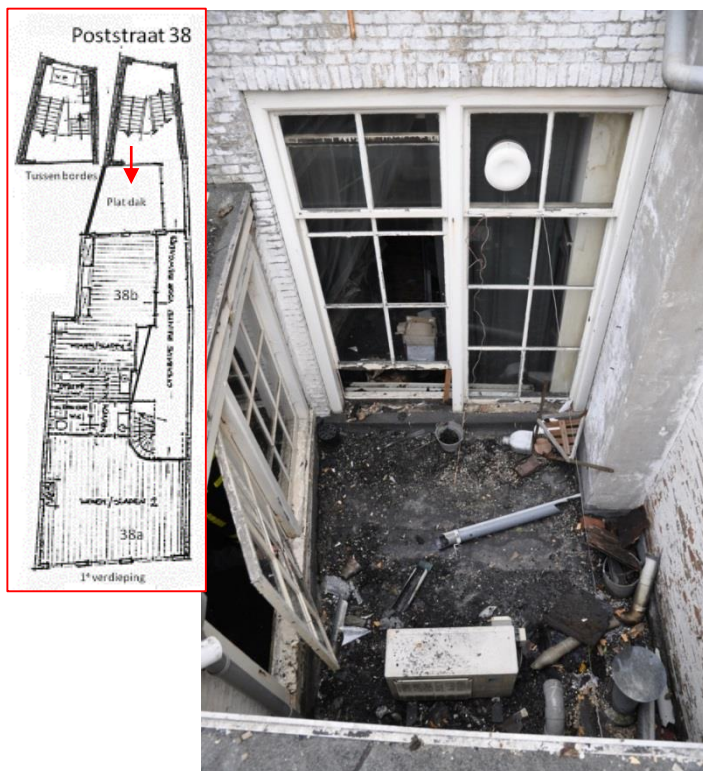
, Openstaand raam appartement nr. 38b, links ramen gang trappenhuis.
